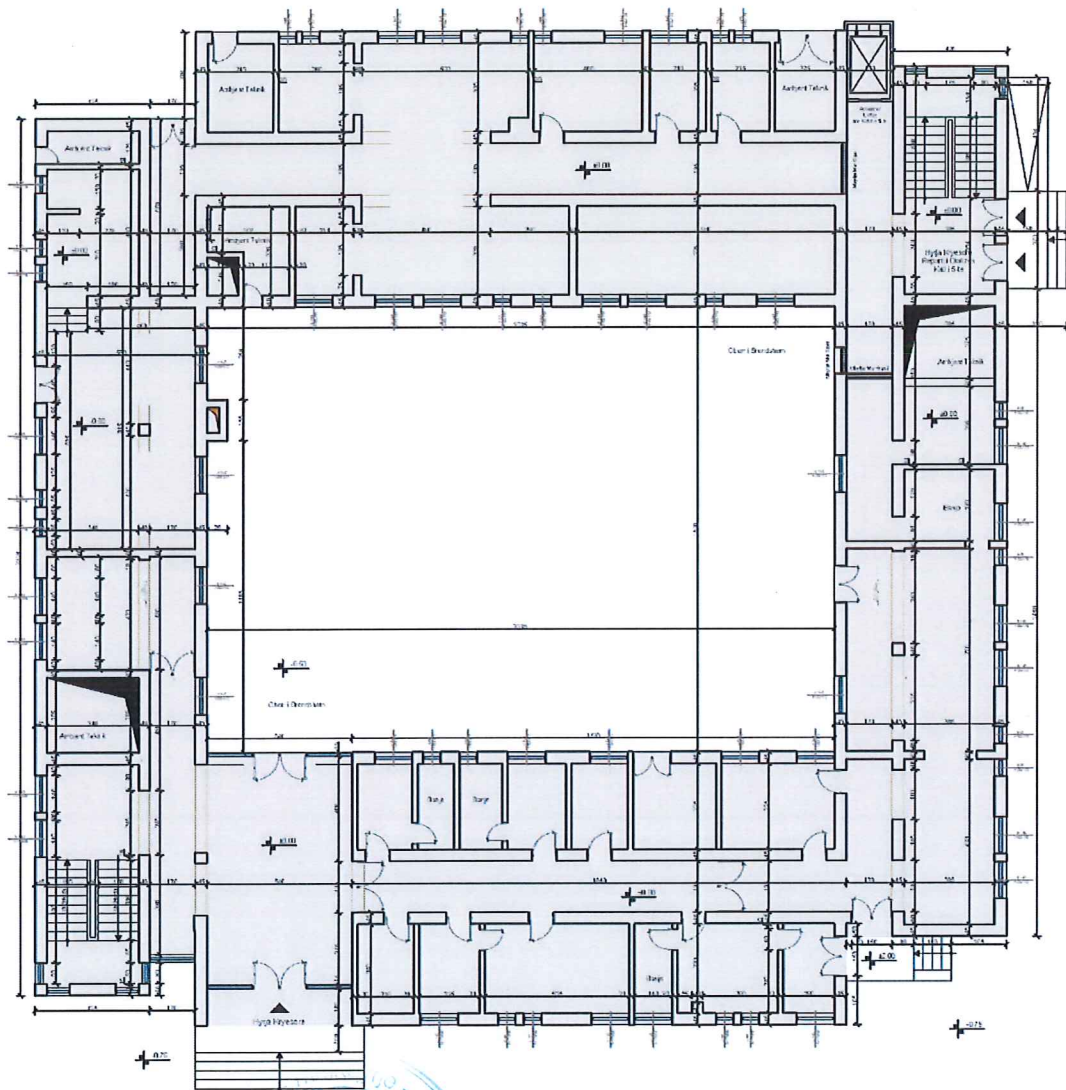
Planimetria e Katit Perdhe (gjendja ekzistuese)
